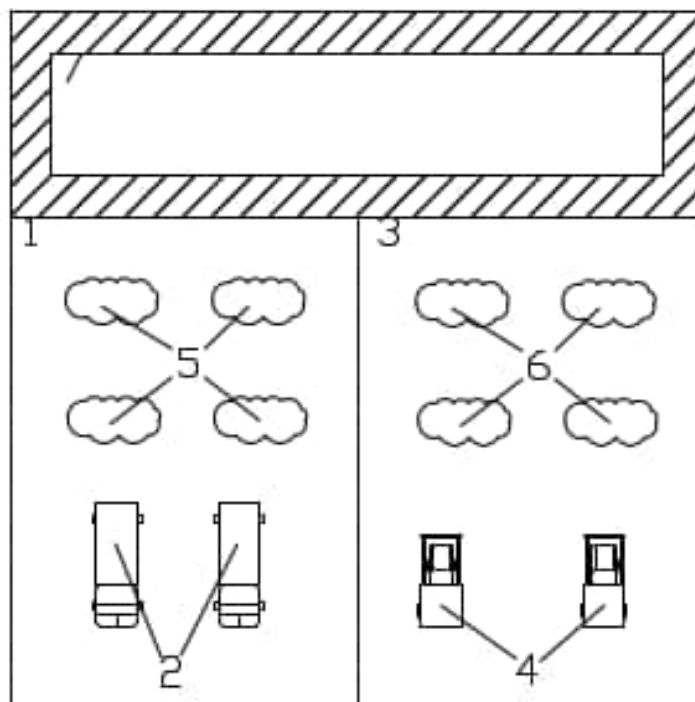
Технология разгрузки самосвалов и работы бульдозеров по сдвиганию грунтов на рабочую карту: 1 – участок разгрузки самосвалов; 2 – самосвалы; 3 – участок сдвигания грунта бульдозерами; 4 – бульдозеры; 5 – грунт выгруженный; 6 – грунты, сдвигаемые бульдозерами на рабочую карту; 7 – рабочая карта
